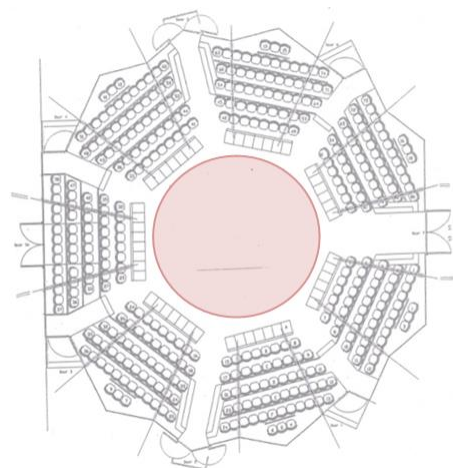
Planta esquemática do Royal Exchange Theatre
